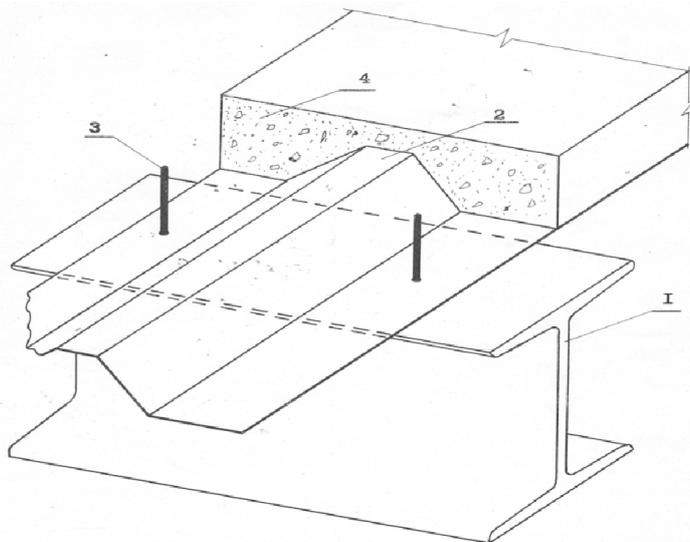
Комбинированная конструкция монолитного перекрытия с внешним армированием
